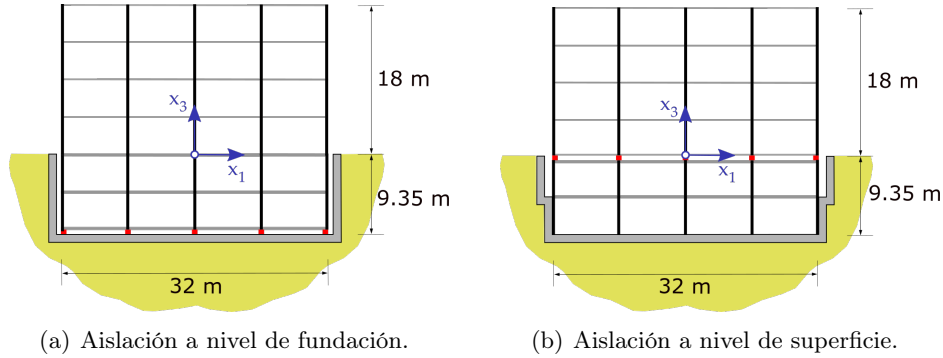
Tipos de estructuras consideradas según ubicación del sistema de aislación.
